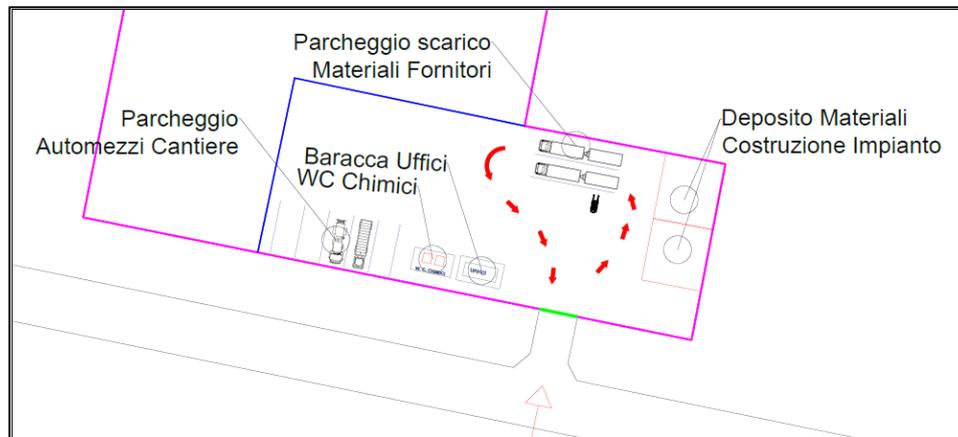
Schema tipo della suddivisione delle aree di cantiere
